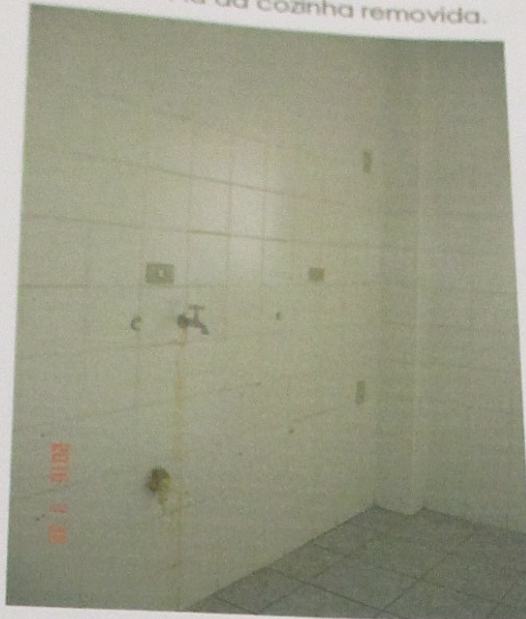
Tanque de lavar roupa da área de serviço removido.
